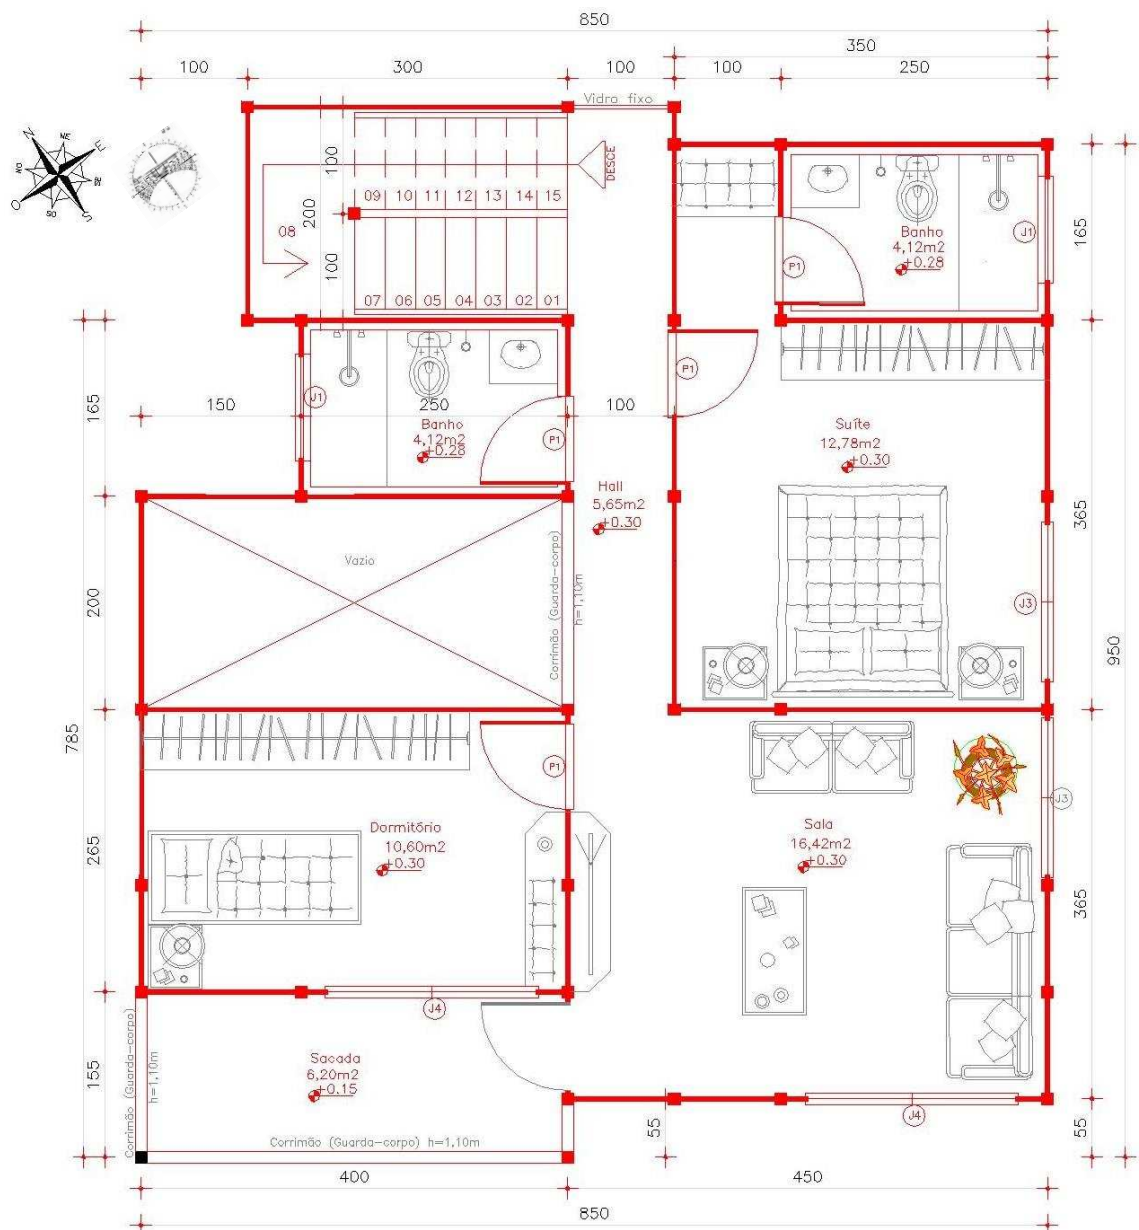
Planta baixa para construção de um pavimento superior, com área total de 69,53m² (para: ZB3; latitude 20°S).
